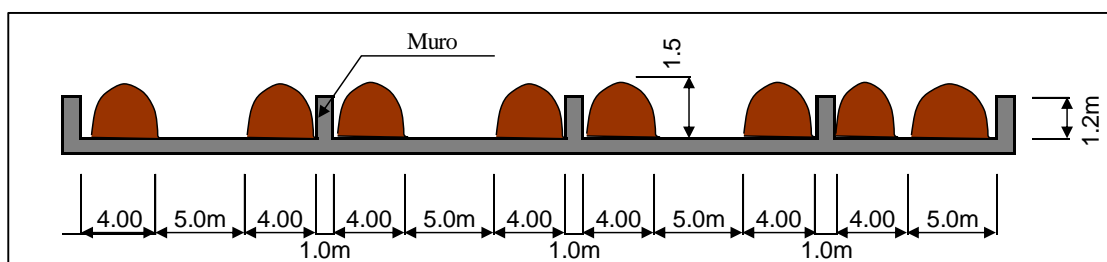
Esquema de planta de compostaje. Elaboración propia.
